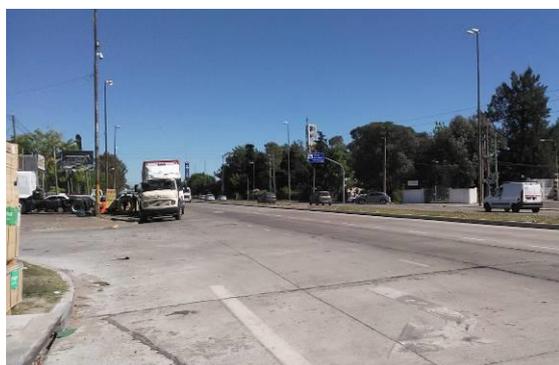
Calzada existente tramo R. de Escalada-Av. Don Bosco
